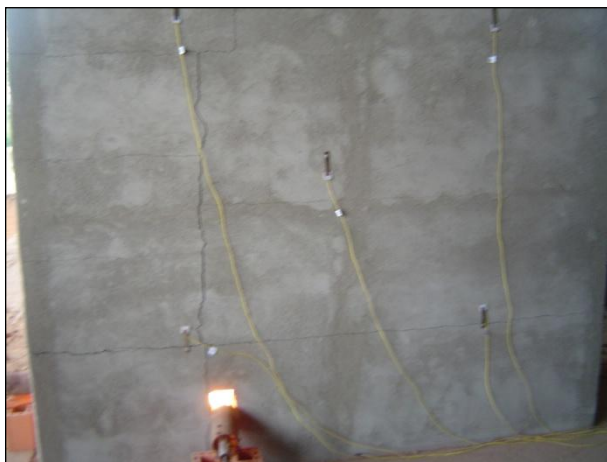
Parede com revestimento no início da fissuração.
